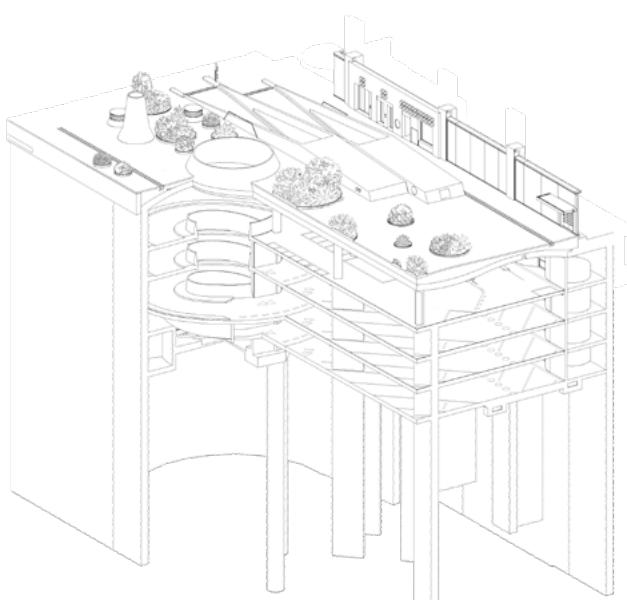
suenter la suspensiun dals portafatschada vegnan plazzads ils elements dal palantschieu sura gnervà.
